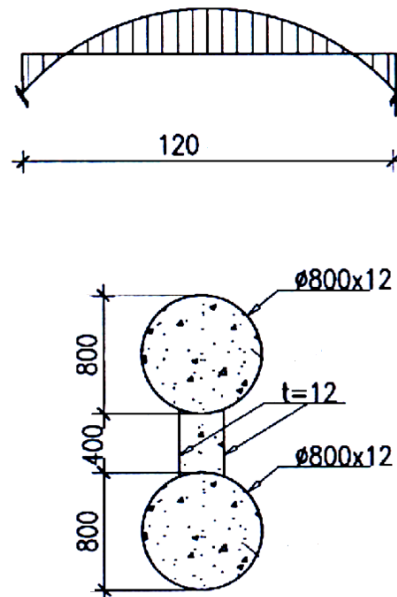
Поперечное сечение несущей арки моста пролетом 120 м из трубобетонных элементов через реку Мо-Зи-Ван в Китае [7]
